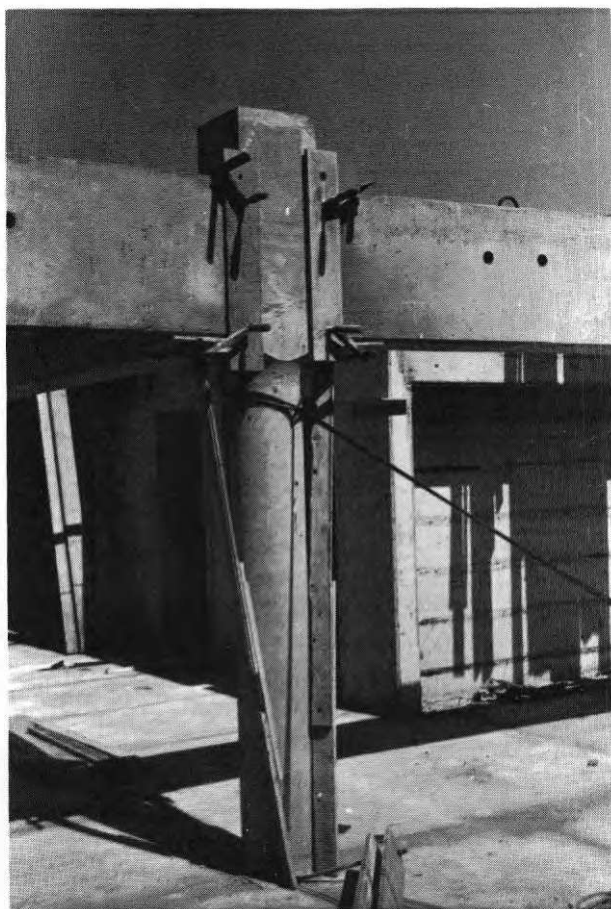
Avformning och renskrapning av anslutning mellan pelare och balk.
